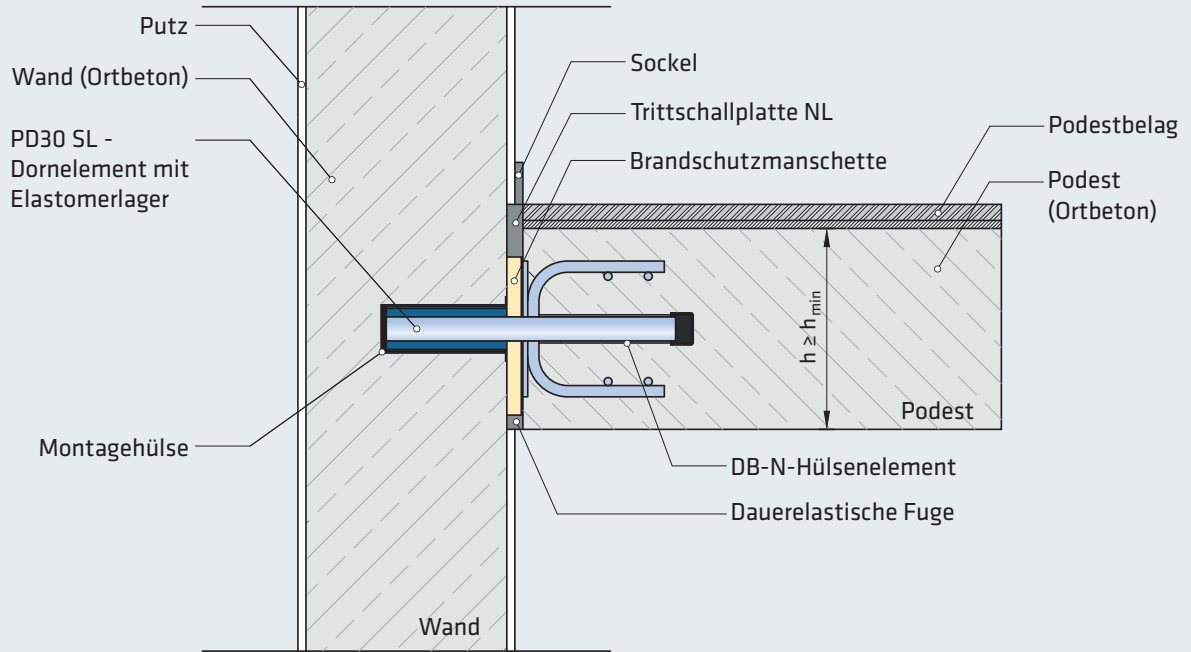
Einbaudetail mit Montagehülse - Ortbetonwand mit Ortbetonpodest
